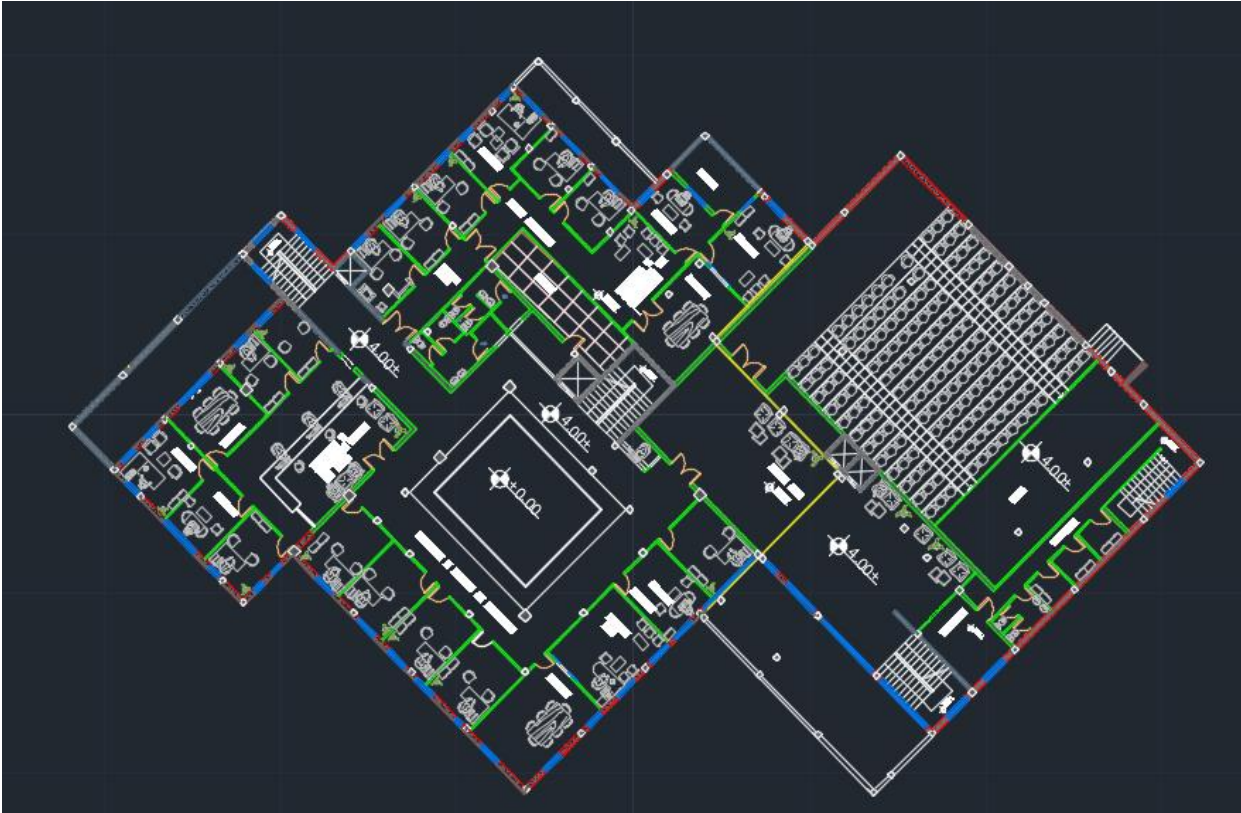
مسقط الأفقي للطابق الأرضي
